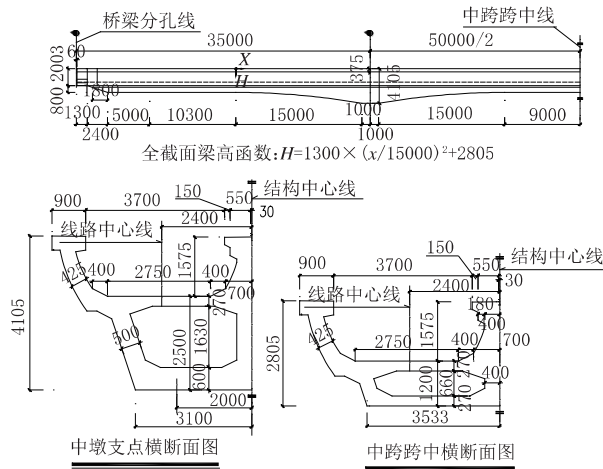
35 m+50 m+35 m 预应力混凝土连续梁立面及横断面图(单位:mm)
